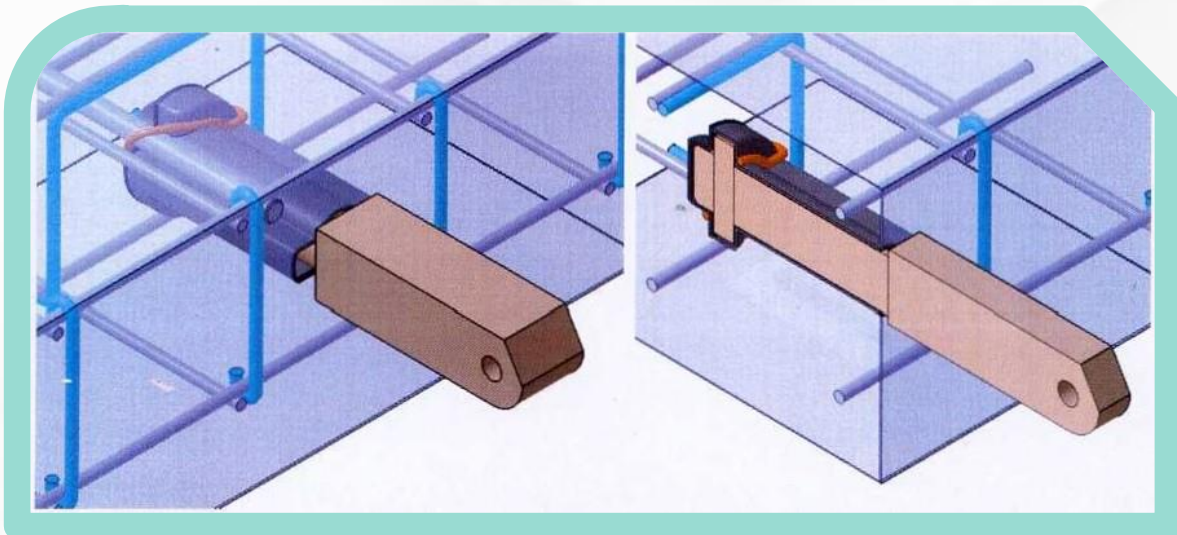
Embebido JUSQ y pieza B0-001 montada.
